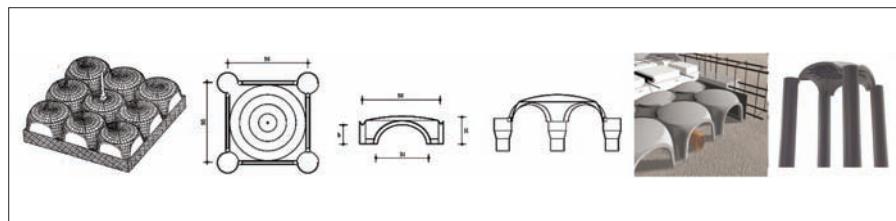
Detalii constructive planșee DALIFORM ATLANTIS
